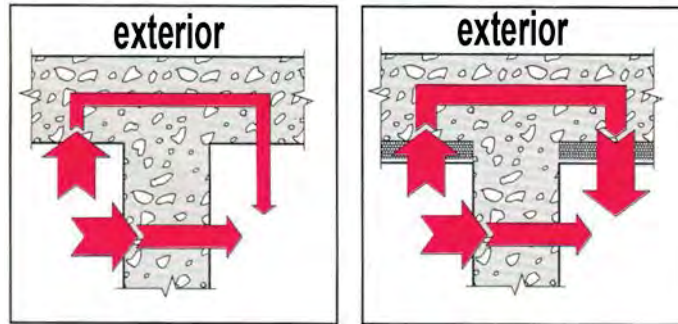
EL AISLANTE RÍGIDO amplifica la transmisión del ruido por el muro de fachada
